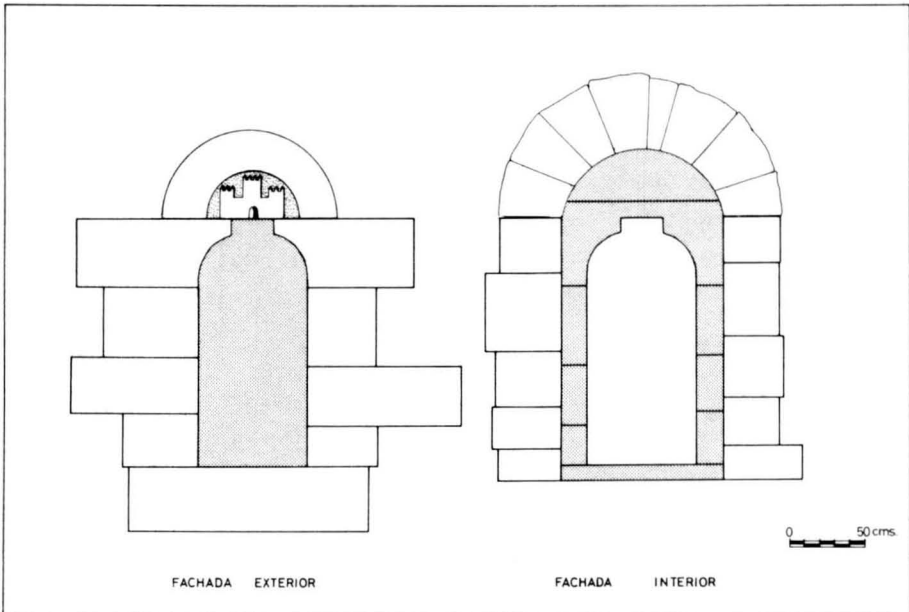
Alzados exterior e interior de la puerta de La Pica.
